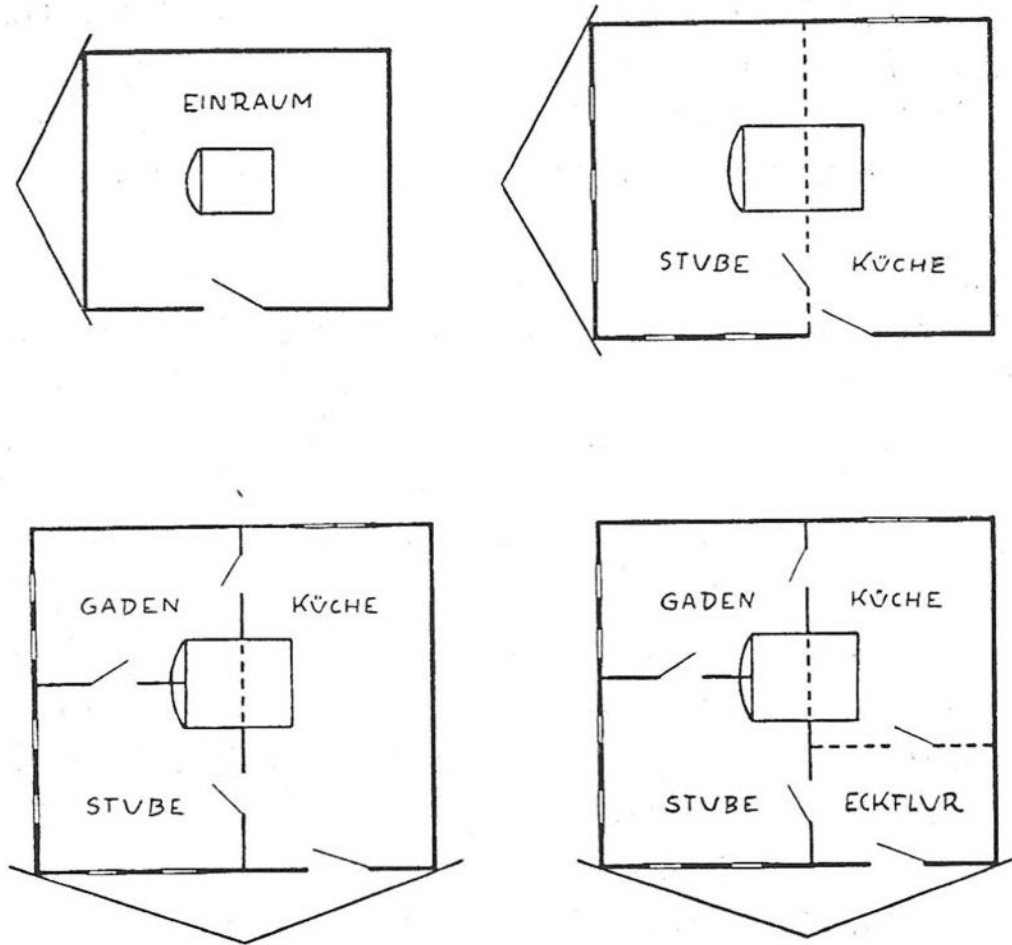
Grundrissentwicklung; vom Einraumhaus zum Eckflurgrundriss
